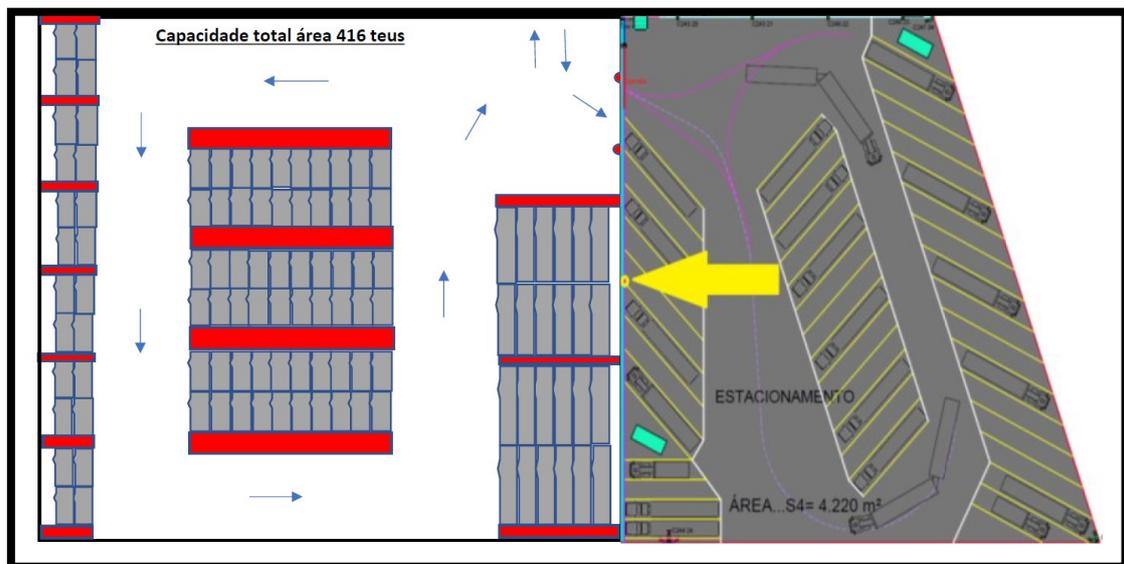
Croqui do estacionamento rotativo da empresa Fassina. Fonte: ANEXO XI - EIV – Planta Fassina.
